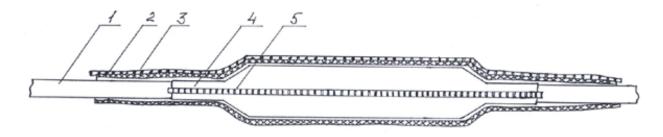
Усадка наружной манжеты на муфту, смонтированную на кабеле с покровом типа «Шп». На кабелях с бронёй и наружными полиэтиленовыми шлангами наружная манжета усаживается аналогично. После усадки наружная манжета должна перекрывать внутреннюю с каждой стороны не менее чем на 70 мм. На муфтах МПВ металлические застёжки манжет могут находиться одна над другой или так, как показано на данном рисунке: 1 — наружный полиэтиленовый шланг; 2 — наружная манжета; 3 — застёжка наружной манжеты.
